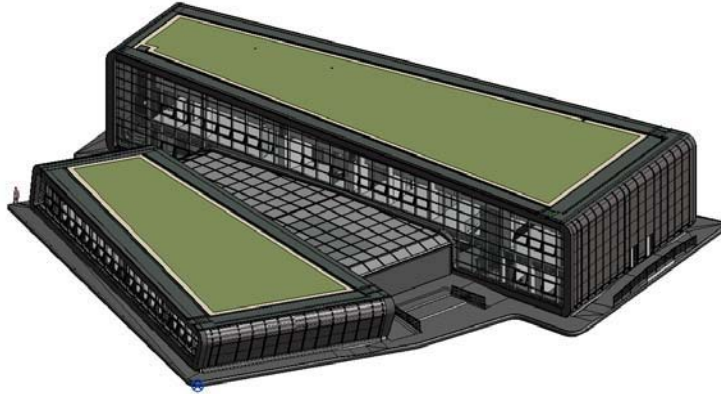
PCC - Vista prospettica dei fabbricati Nord Ovest
